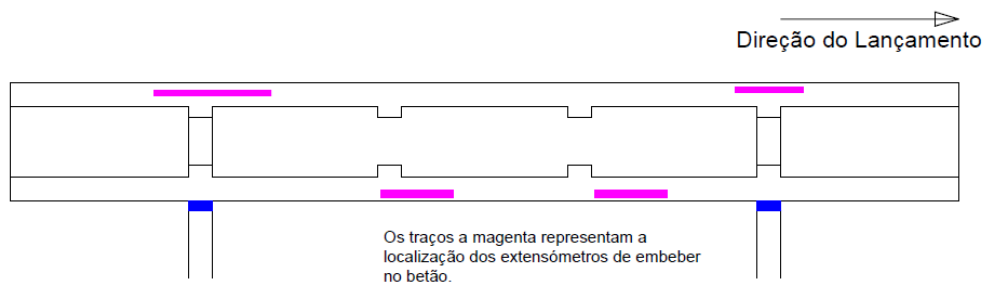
Esquema da localização dos extensómetros de embeber no betão.
